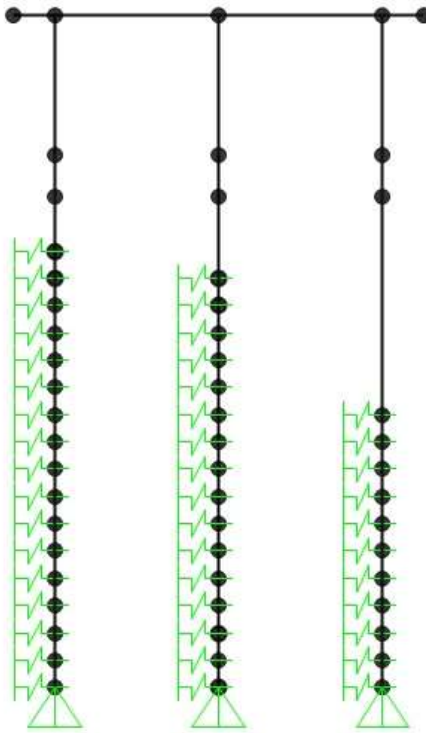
Vista General sin cargas de Pórtico de Apoyo.
